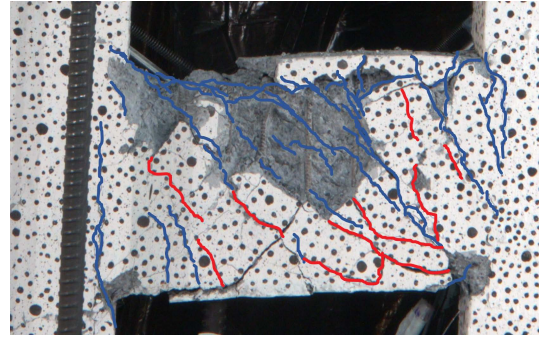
Grietas Vigas a 2 % Drift
